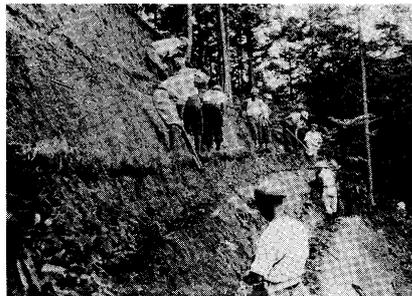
積苗工に使う切芝の現地採取⁷⁾写真-3.9 積苗工の施工状況⁷⁾
